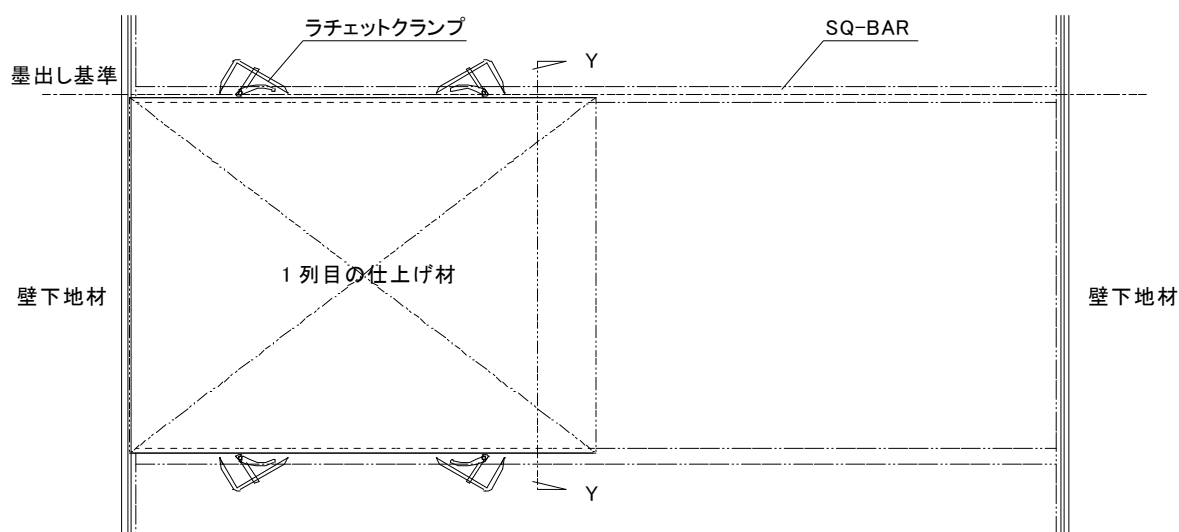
1 列目の仕上げ材の取付け(平面図)
